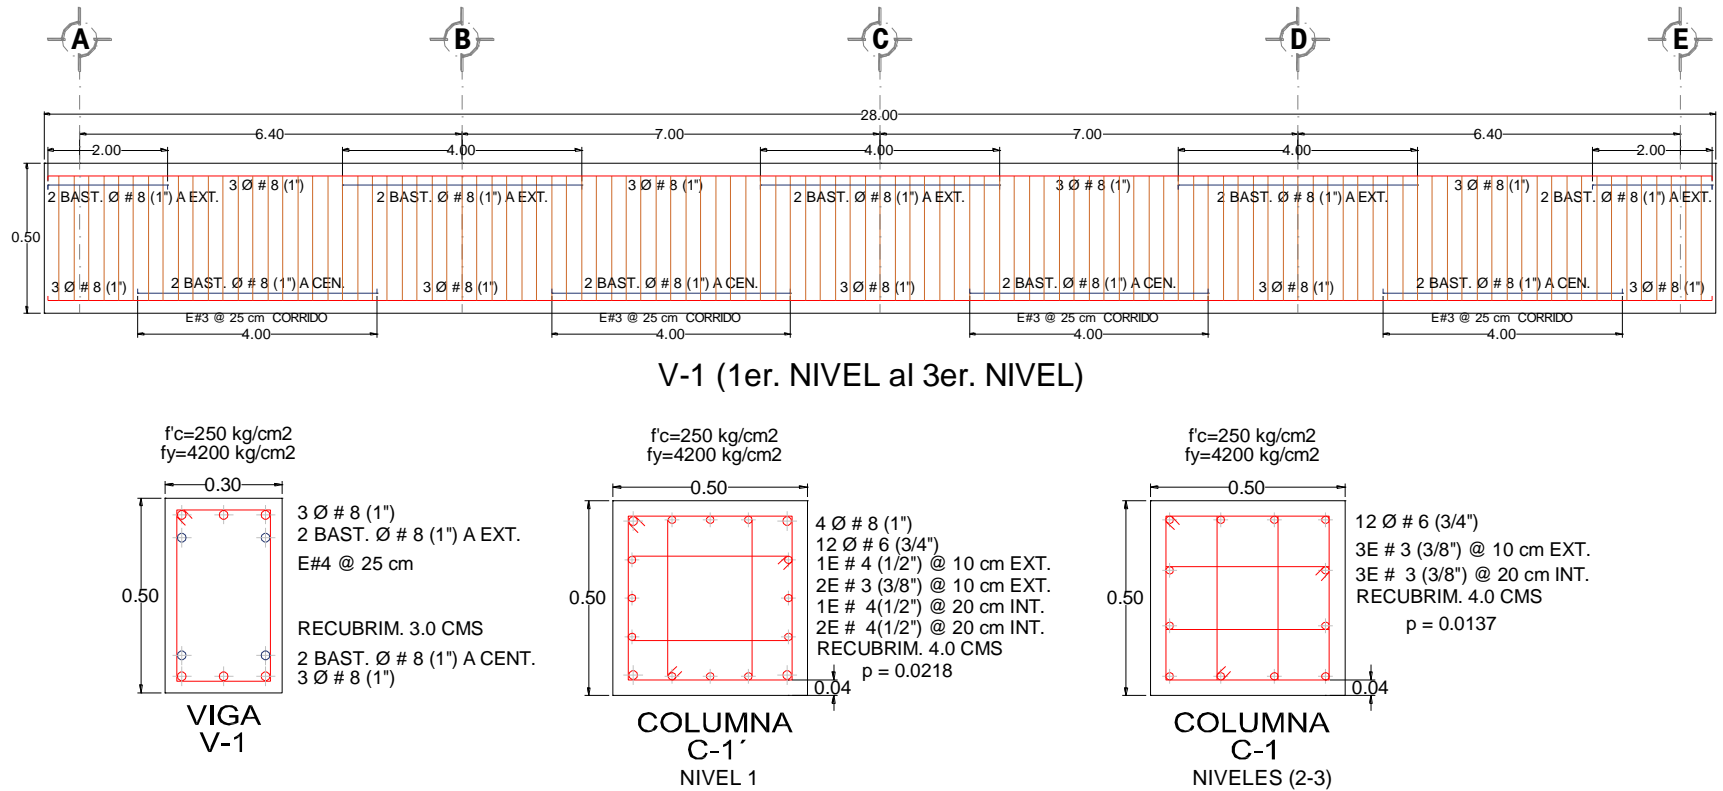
Detallado de armado de elementos del marco de 3 niveles con base a secciones gruesas.
